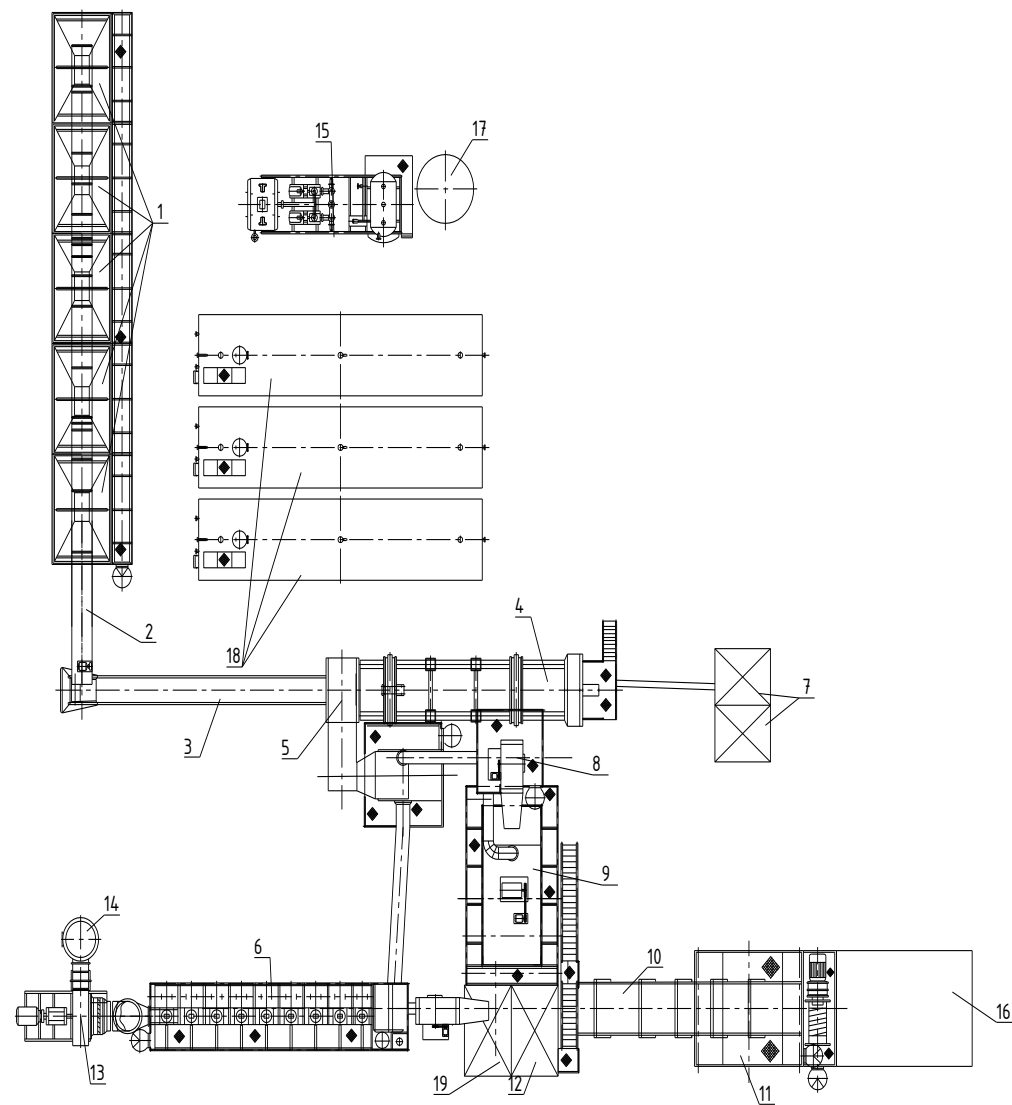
Схема асфальтобетонного завода RD – 175
